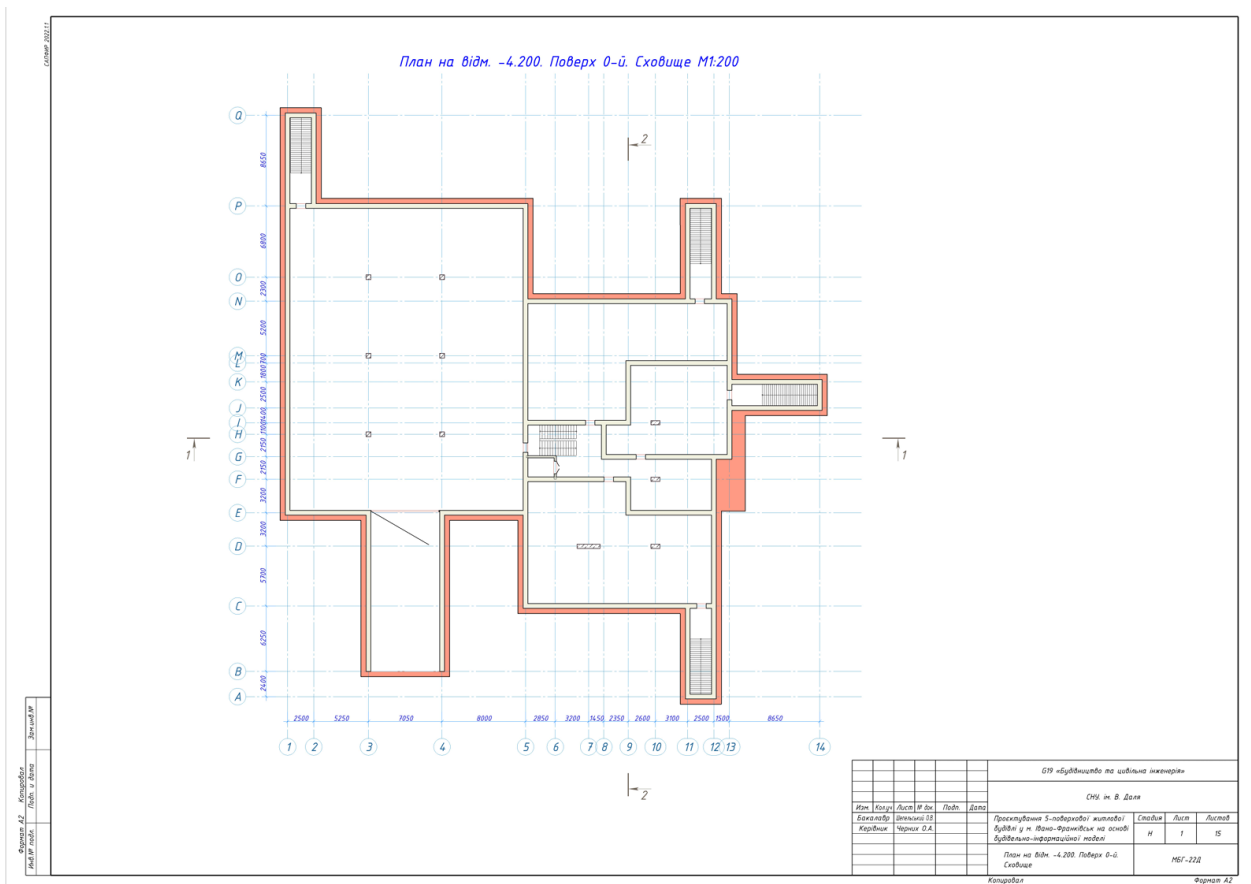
План на відм. -4.200. Поверх 0-й. Сховище
